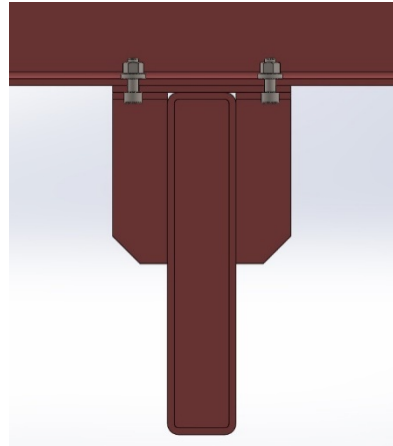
Detalle de la unión entre viga y subestructura de carga
